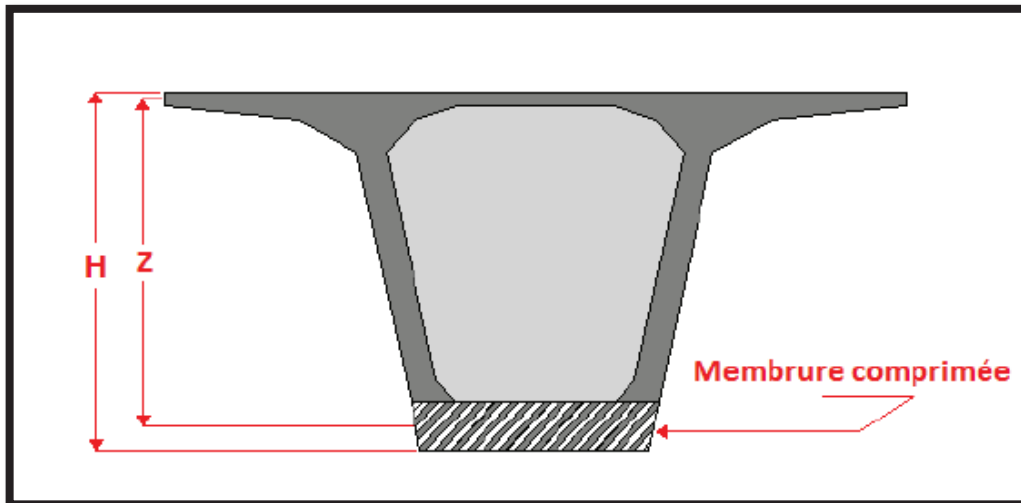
Prise en compte de l'effet RESAL sur les poutres caisson.
